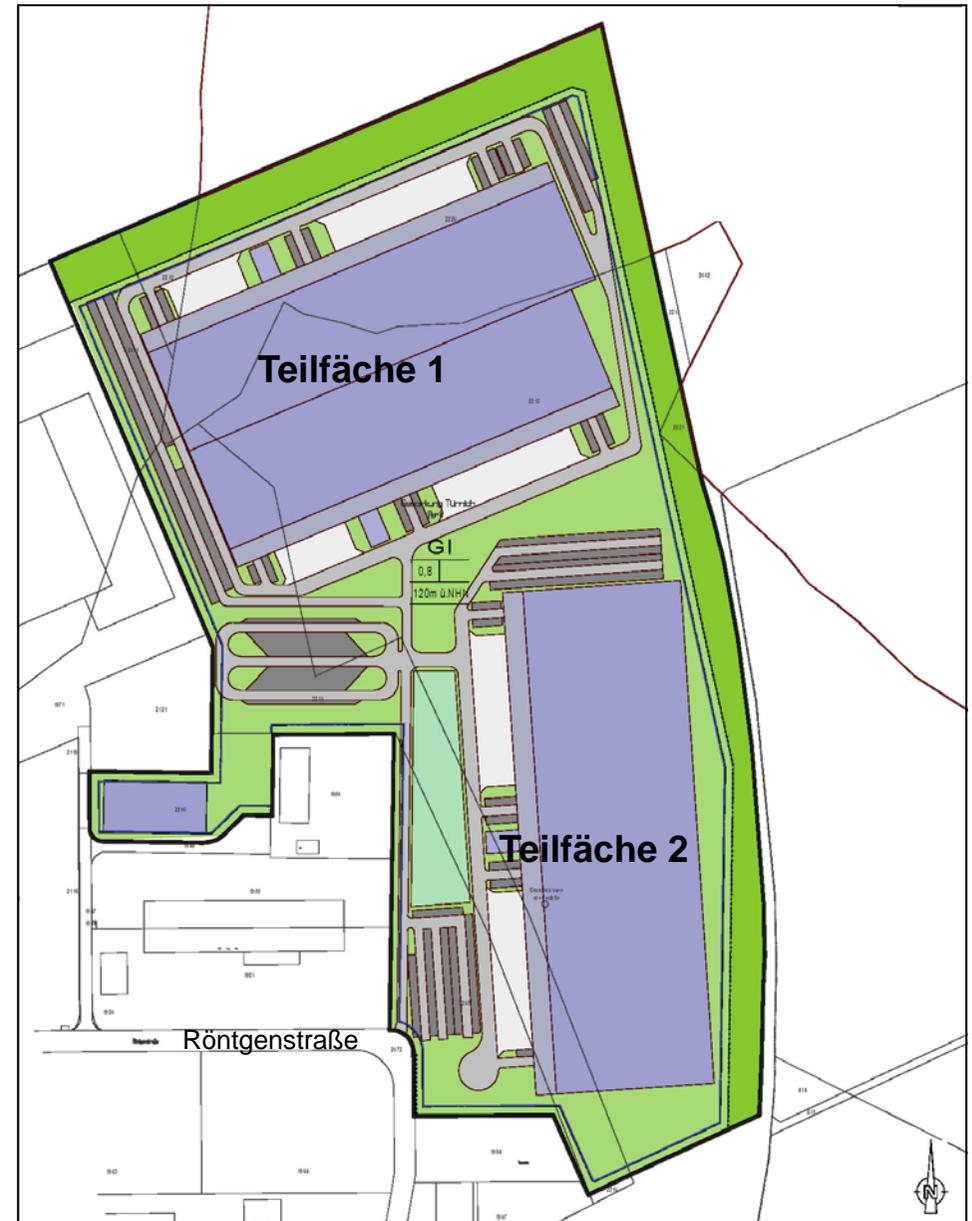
Städtebaulicher Entwurf Bebauungsplan Tü 373 (Stand: 02/2019)
